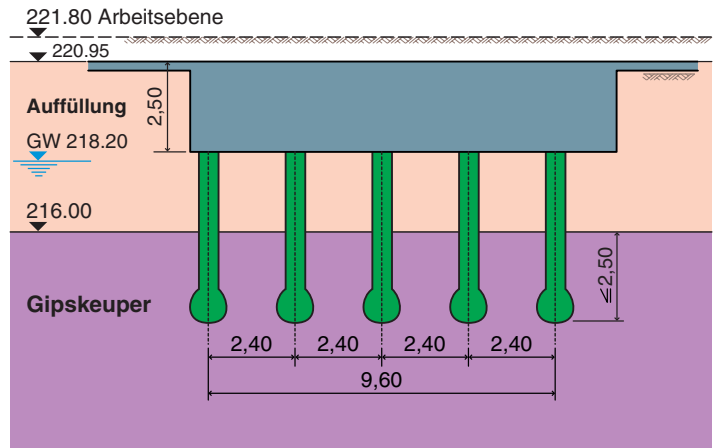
Pfahlplan des Museumsgebäudes mit Schnitten
